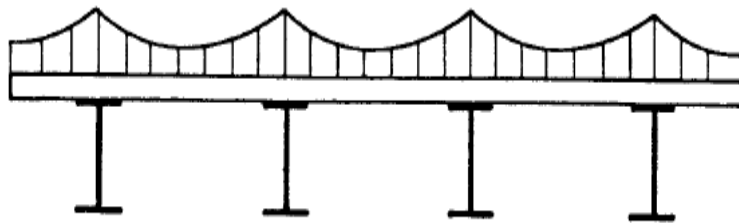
Distribuição de tensões longitudinais no banzo de betão (laje) devido ao efeito de Shear lag (Malite, 1990)
